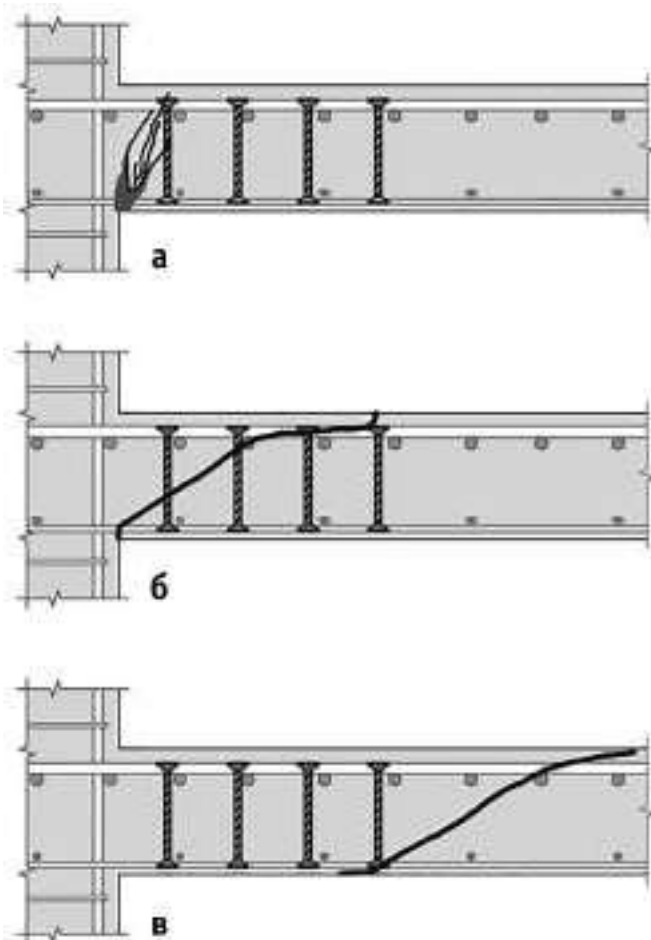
Расчётные сечения на продавливание плиты с поперечным армированием: а – разрушение по грани колонны; б – разрушение в зоне поперечного армирования; в – разрушение за зоной поперечного армирования
